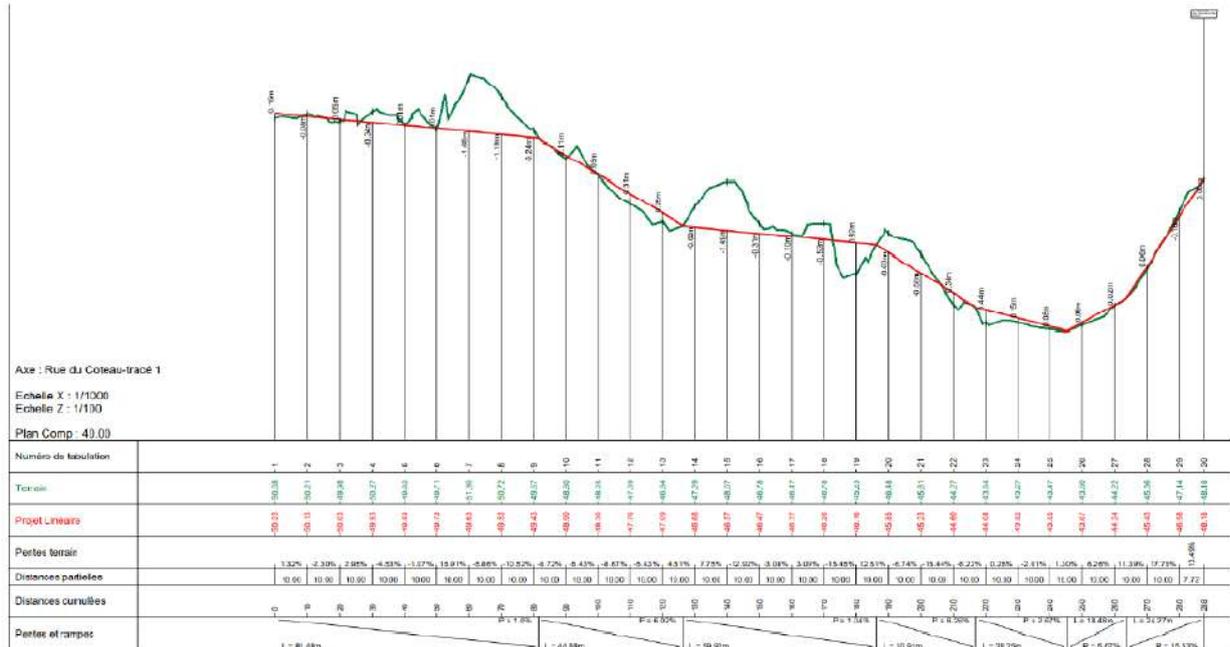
Profil en long de la rue des coteaux -secteur 2
